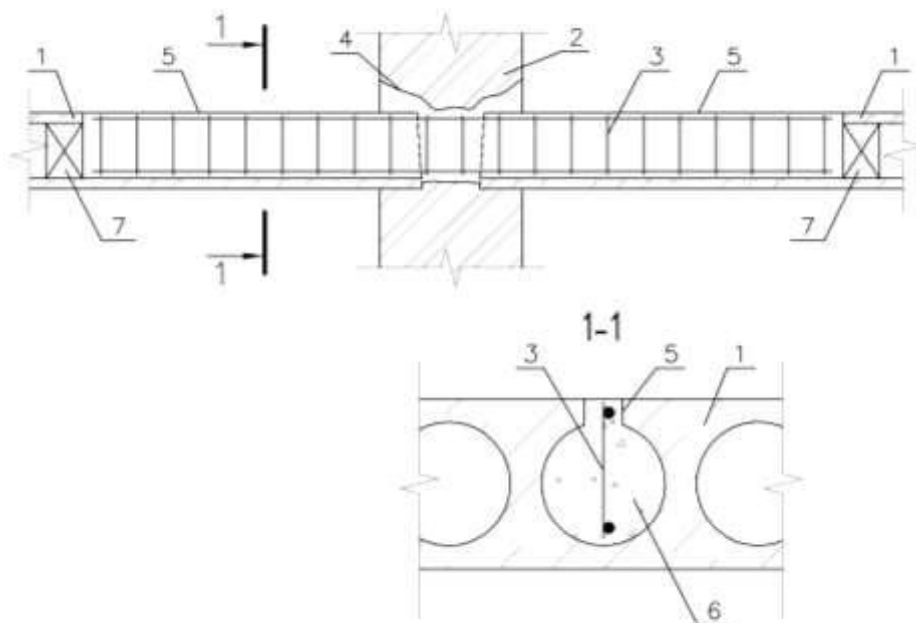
Установка надпорных арматурных каркасов в пустотах
